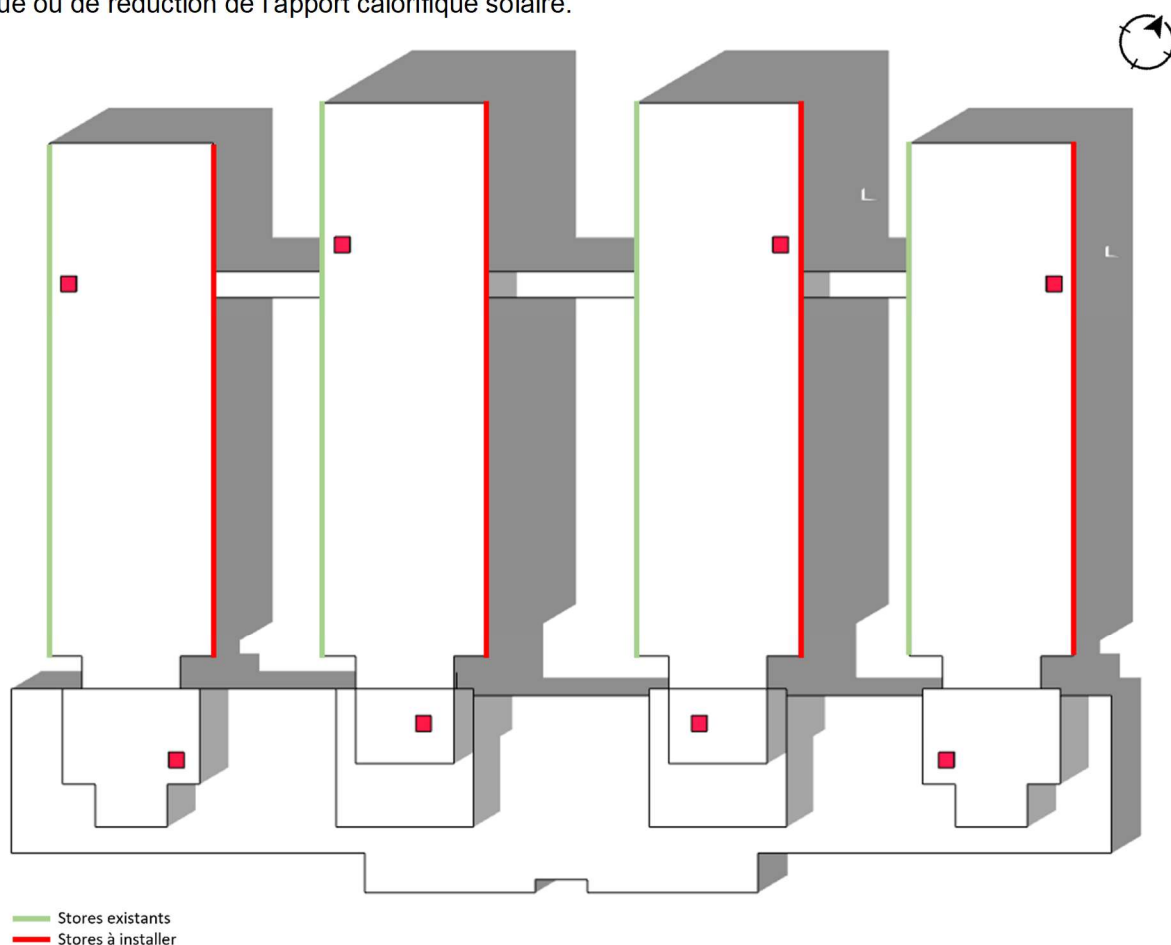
Vue en plan - Localisation des stores installés et à installer
